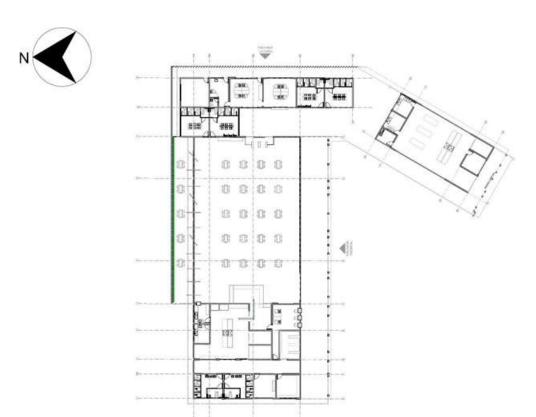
Planta Baixa – s/escala Fonte: autora, 2020.
